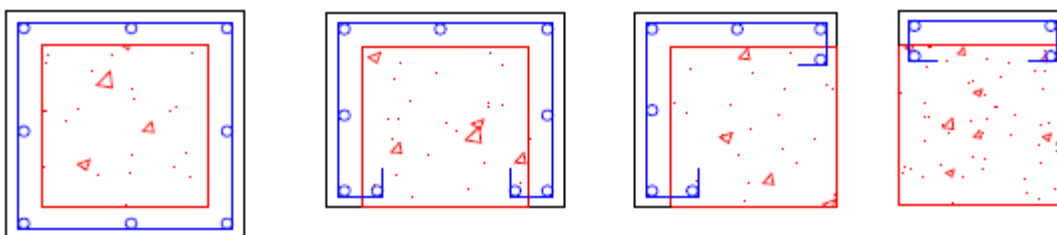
Reforço de pilar por aumento de seção e taxa de armadura
